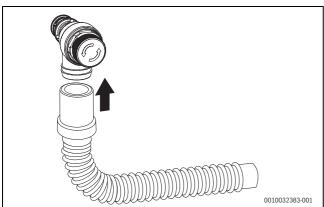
Montage du tube sur la soupape de sécurité (chauffage)
